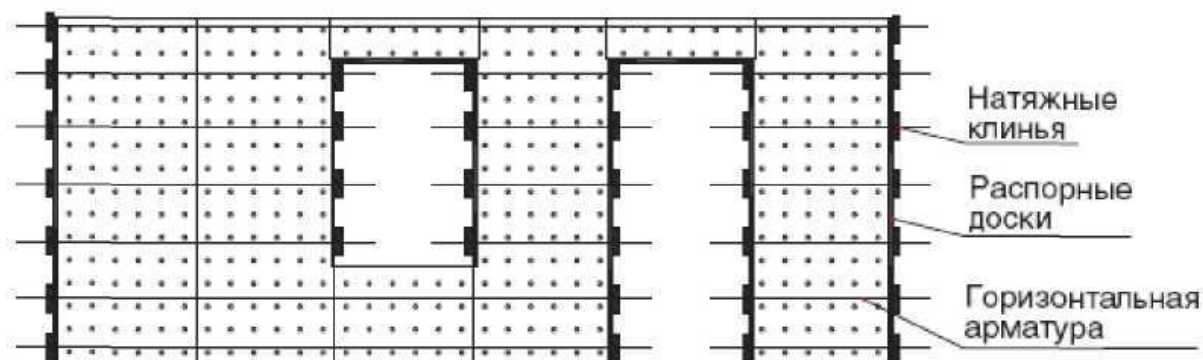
Схема размещения арматуры в элементах стеновой опалубки.
